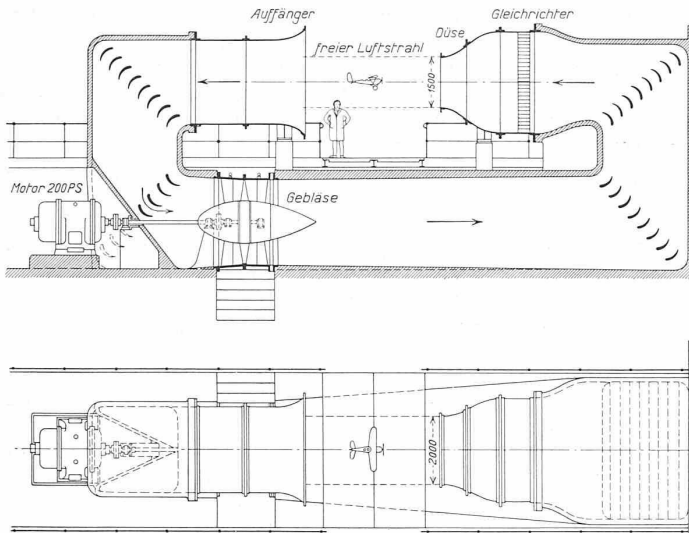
Windkanal mit halbgeschlossenem Umlauf. — Schnitt und Grundriss 1 : 200.
